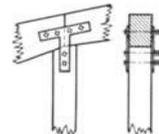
Verbindung eines Pfostens mit einem einteiligen Kranzholz in einem Lehrgerüst.
